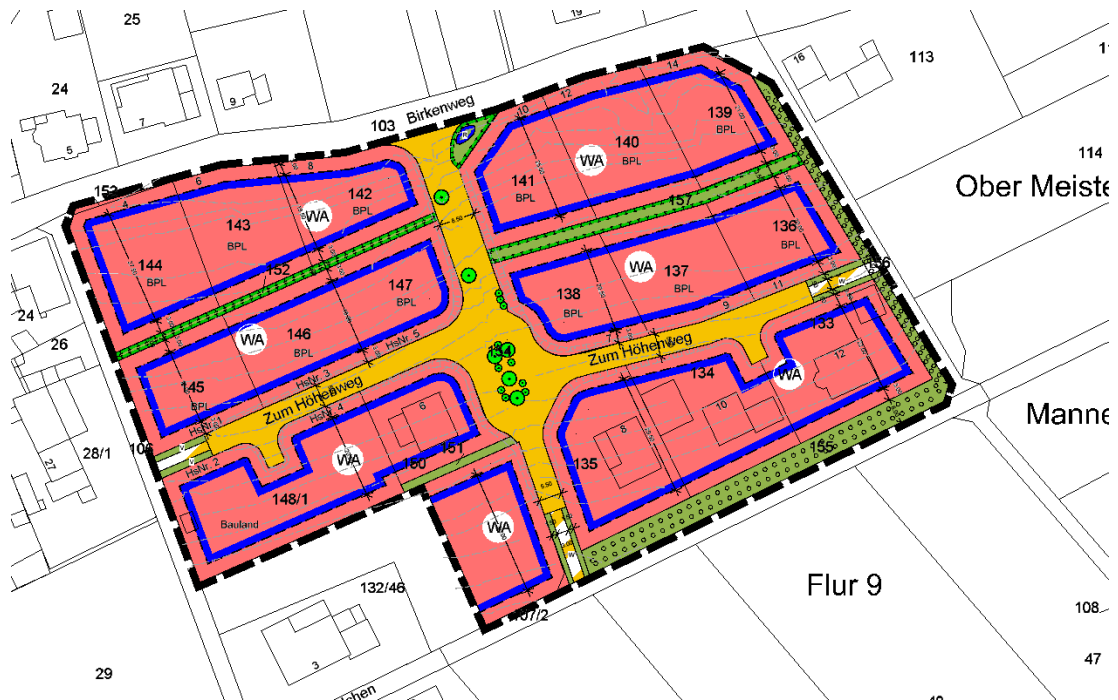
Darstellung der 1. Änderung Bebauungsplan 'Auf Sickert',
